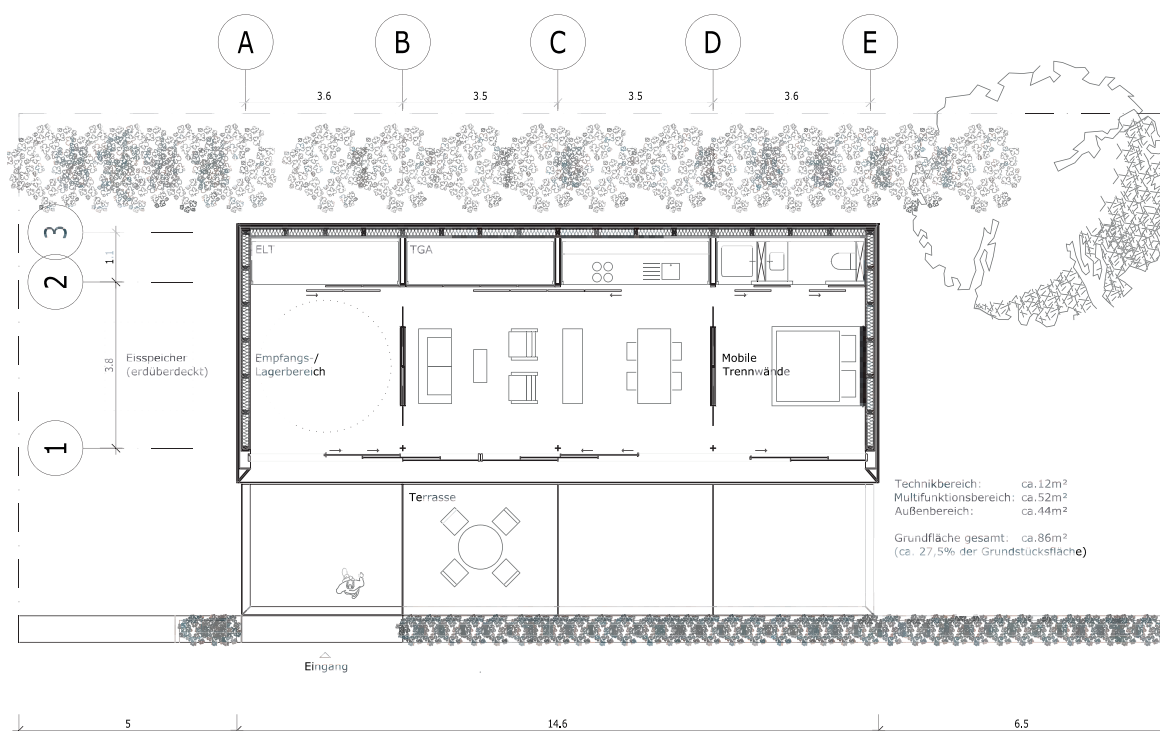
Grundriss des Aktivhaus B10 [43]
